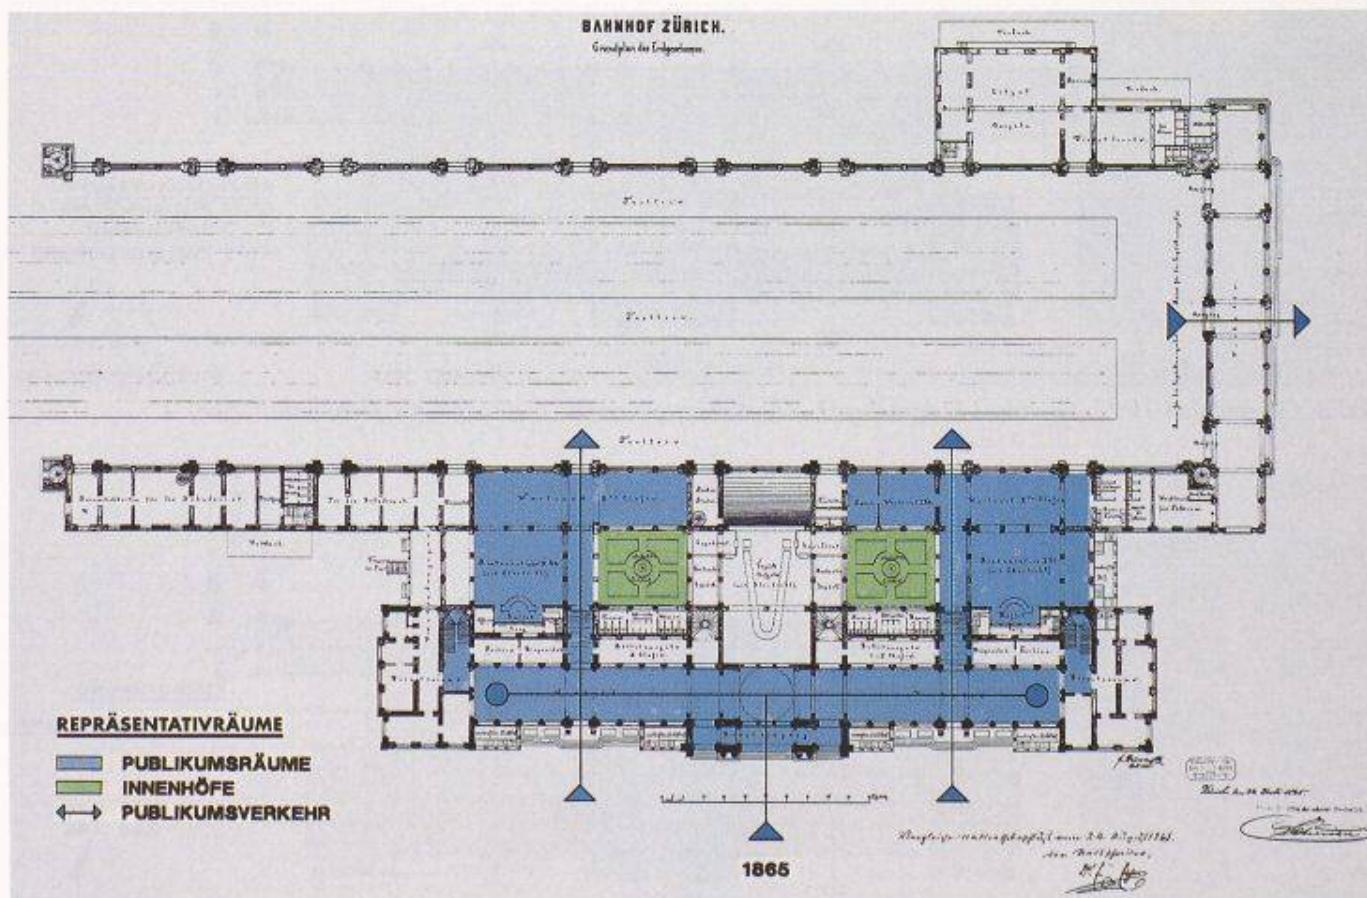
Baueingabeplan 1865 von J.F. Wanner für den Zürcher Hauptbahnhof (Grundriss Erdgeschoss). Repräsentativräume und Innenhöfe
